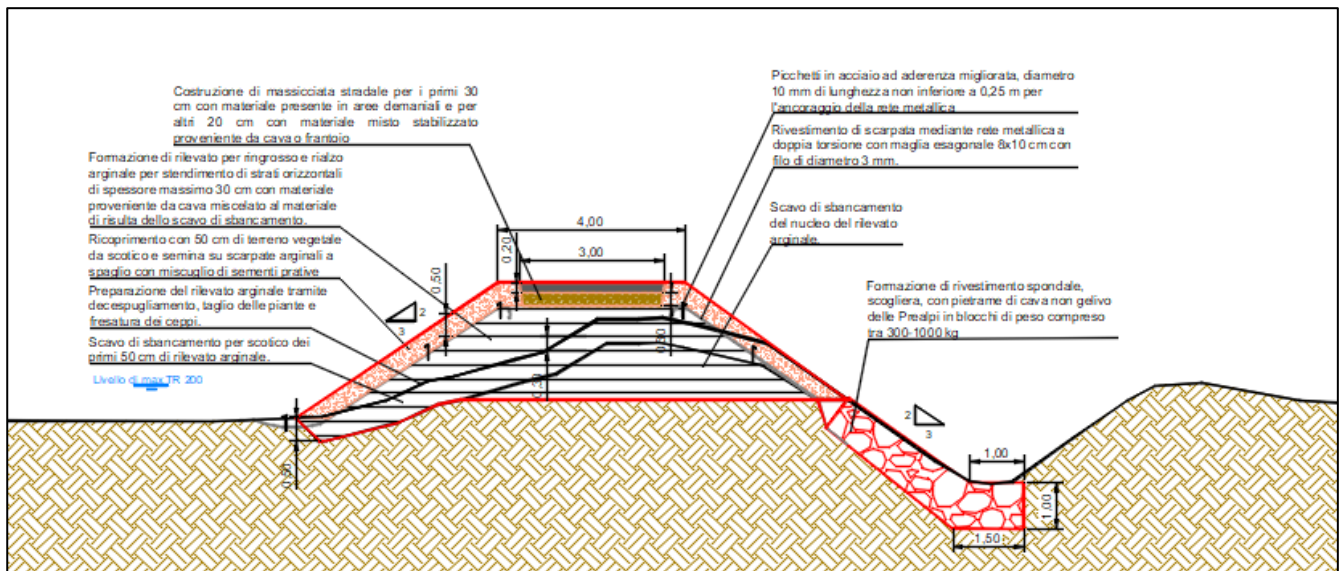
SEZIONE TIPOLOGICA DELL'INTERVENTO 1
